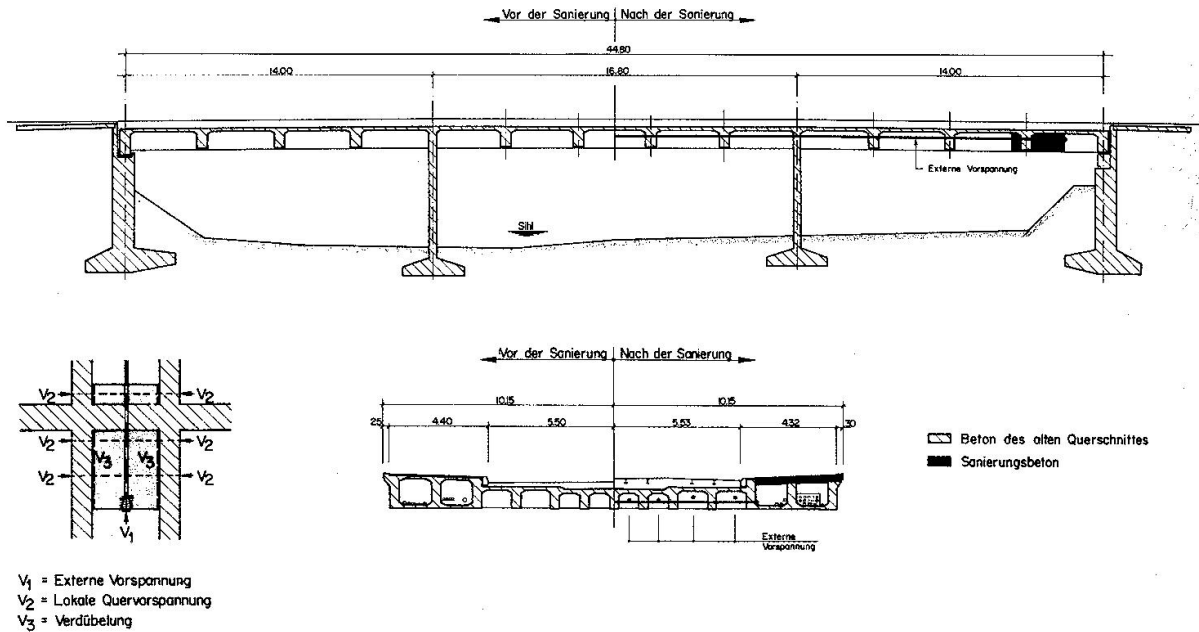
Renforcement du pont Gessner à Zürich : coupe longitudinale (en haut), introduction des forces (en bas à gauche) et coupe transversale (en bas à droite).
